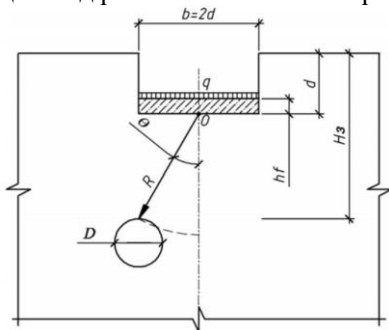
Общий вид расчетной схемы задачи об устойчивости горизонтальной подземной незакрепленной круглой выработки
